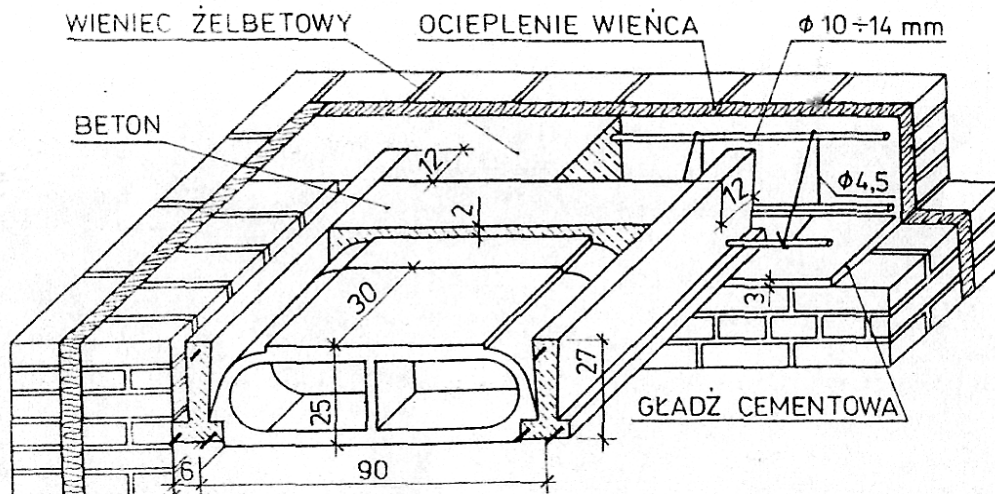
Konstrukcja stropu gęstożebrowego typu DZ-3 ułożonego na belkach żelbetowych prefabrykowanych DZ-3, z fragmentem żebra rozdzielczego [1, s. 57]
